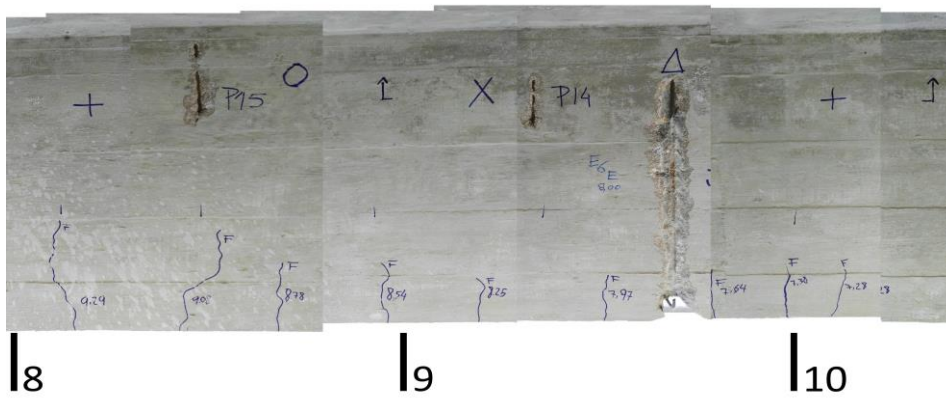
Foto da viga esquerda entre os 8 e 10,5 metros
